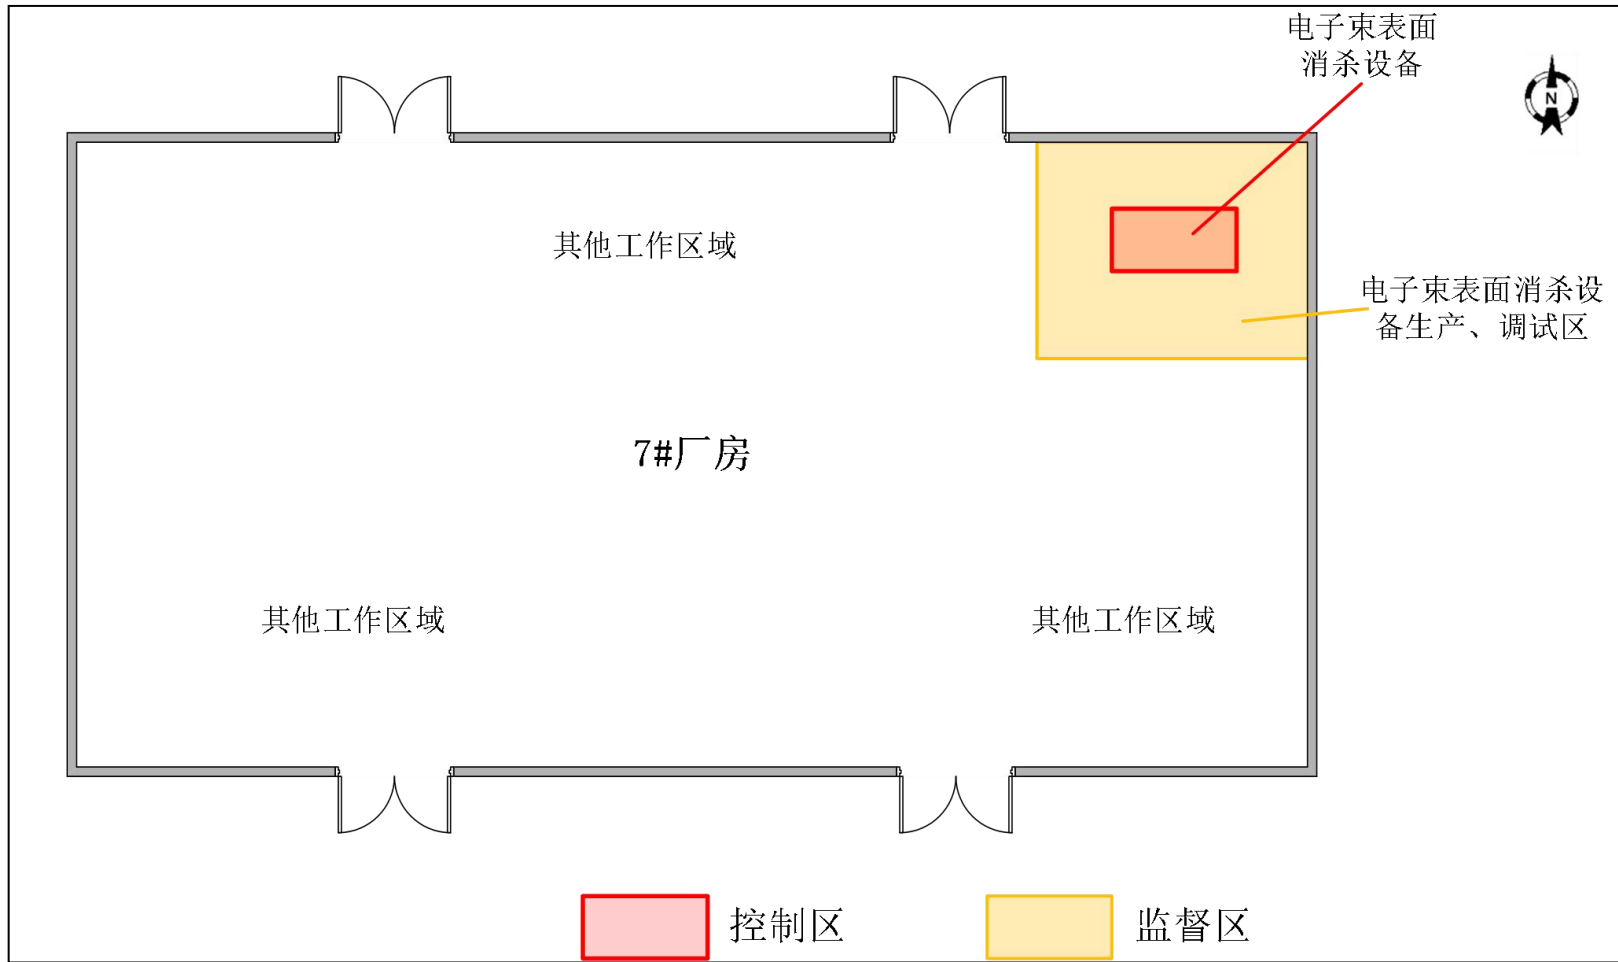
本项目生产、调试工作场所平面布置及两区划分示意图
